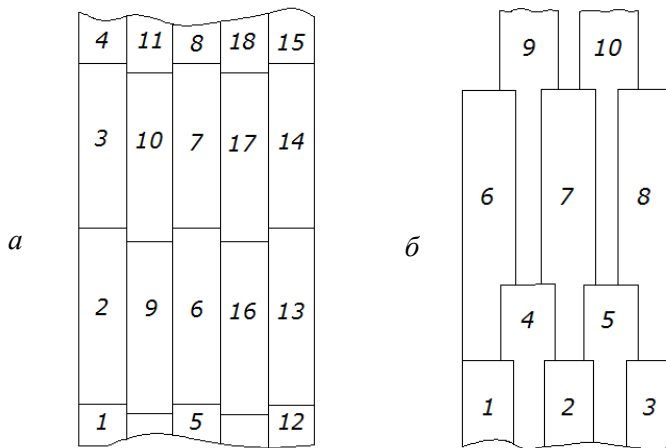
Схеми набирання ґрунту скрепером у плані:
